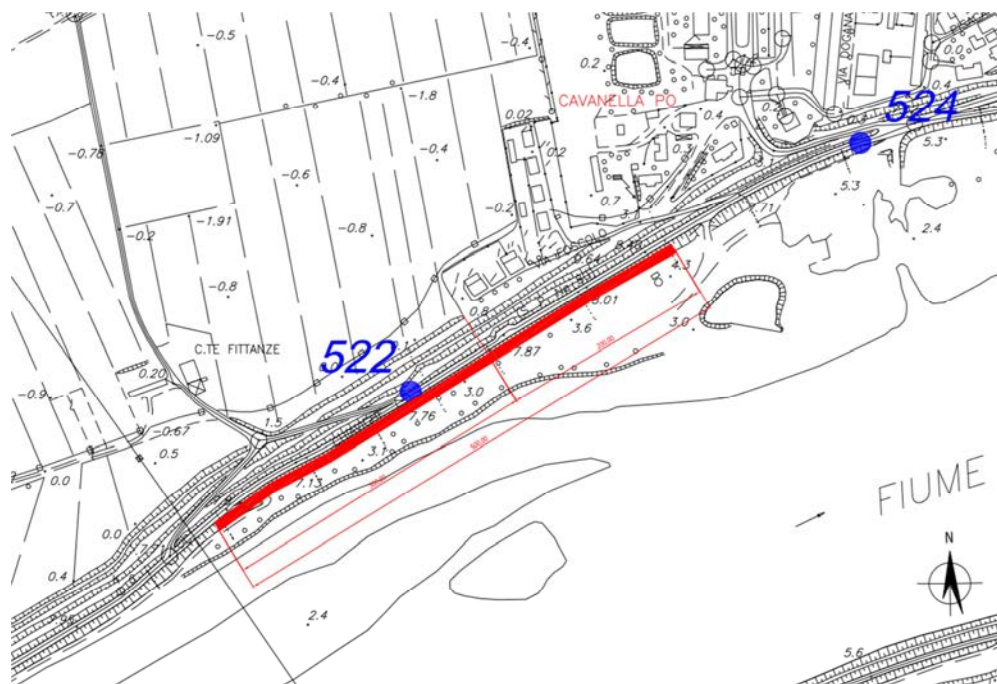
Planimetria con la localizzazione dell'area di scavo
